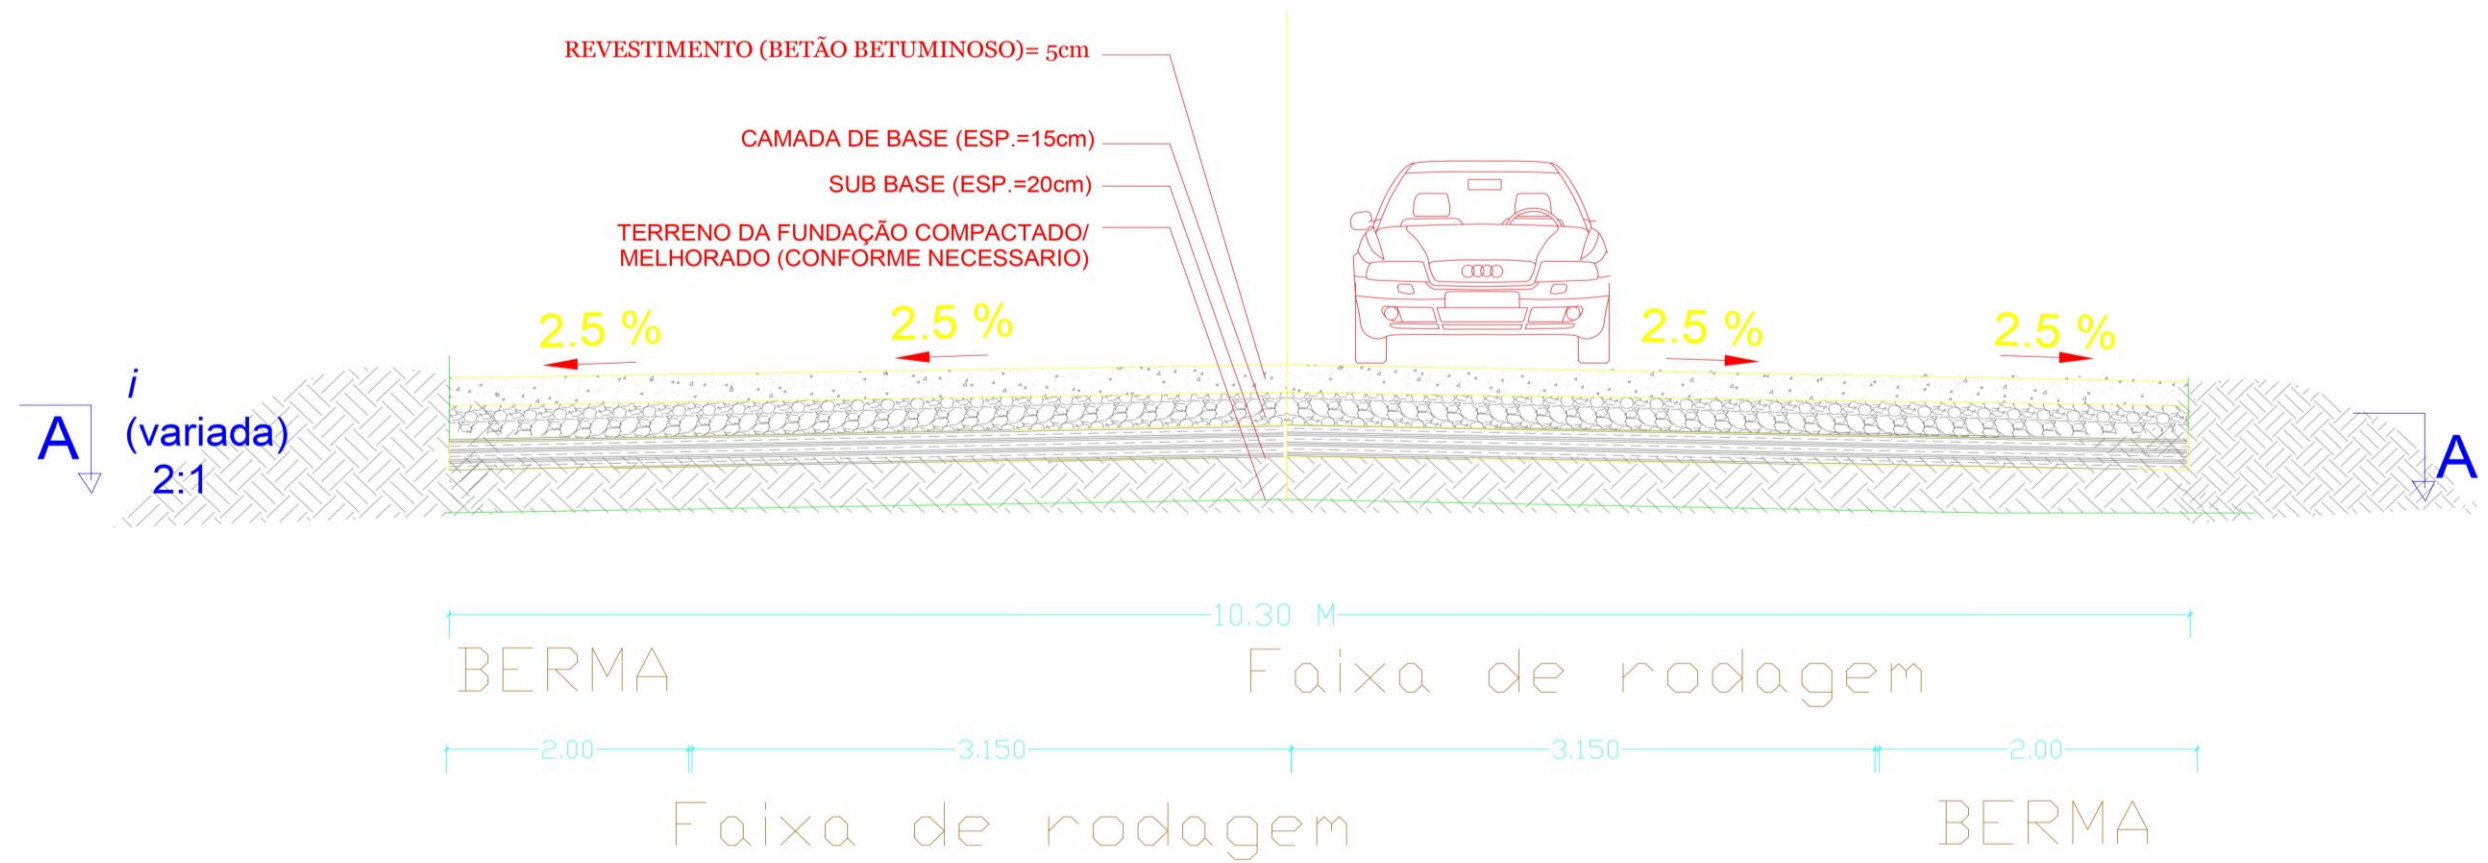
Seccão tipo do pavimento, H3-T4-R. ESCALA: 1:100. (Autor 2023.)
